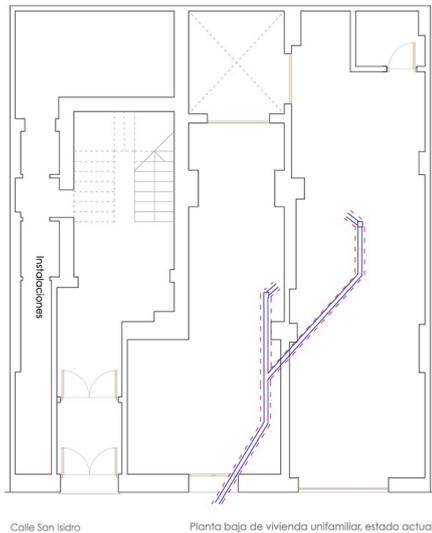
Ubicación y dimensiones de las zanjas para el saneamiento sobre planta de estado actual.
